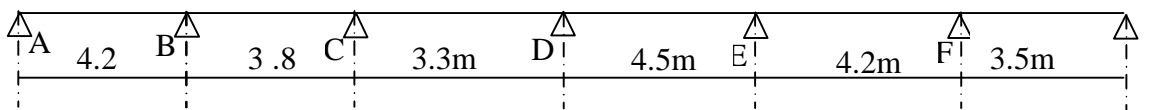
Schéma du 1<sup>er</sup> type de poutrelle
